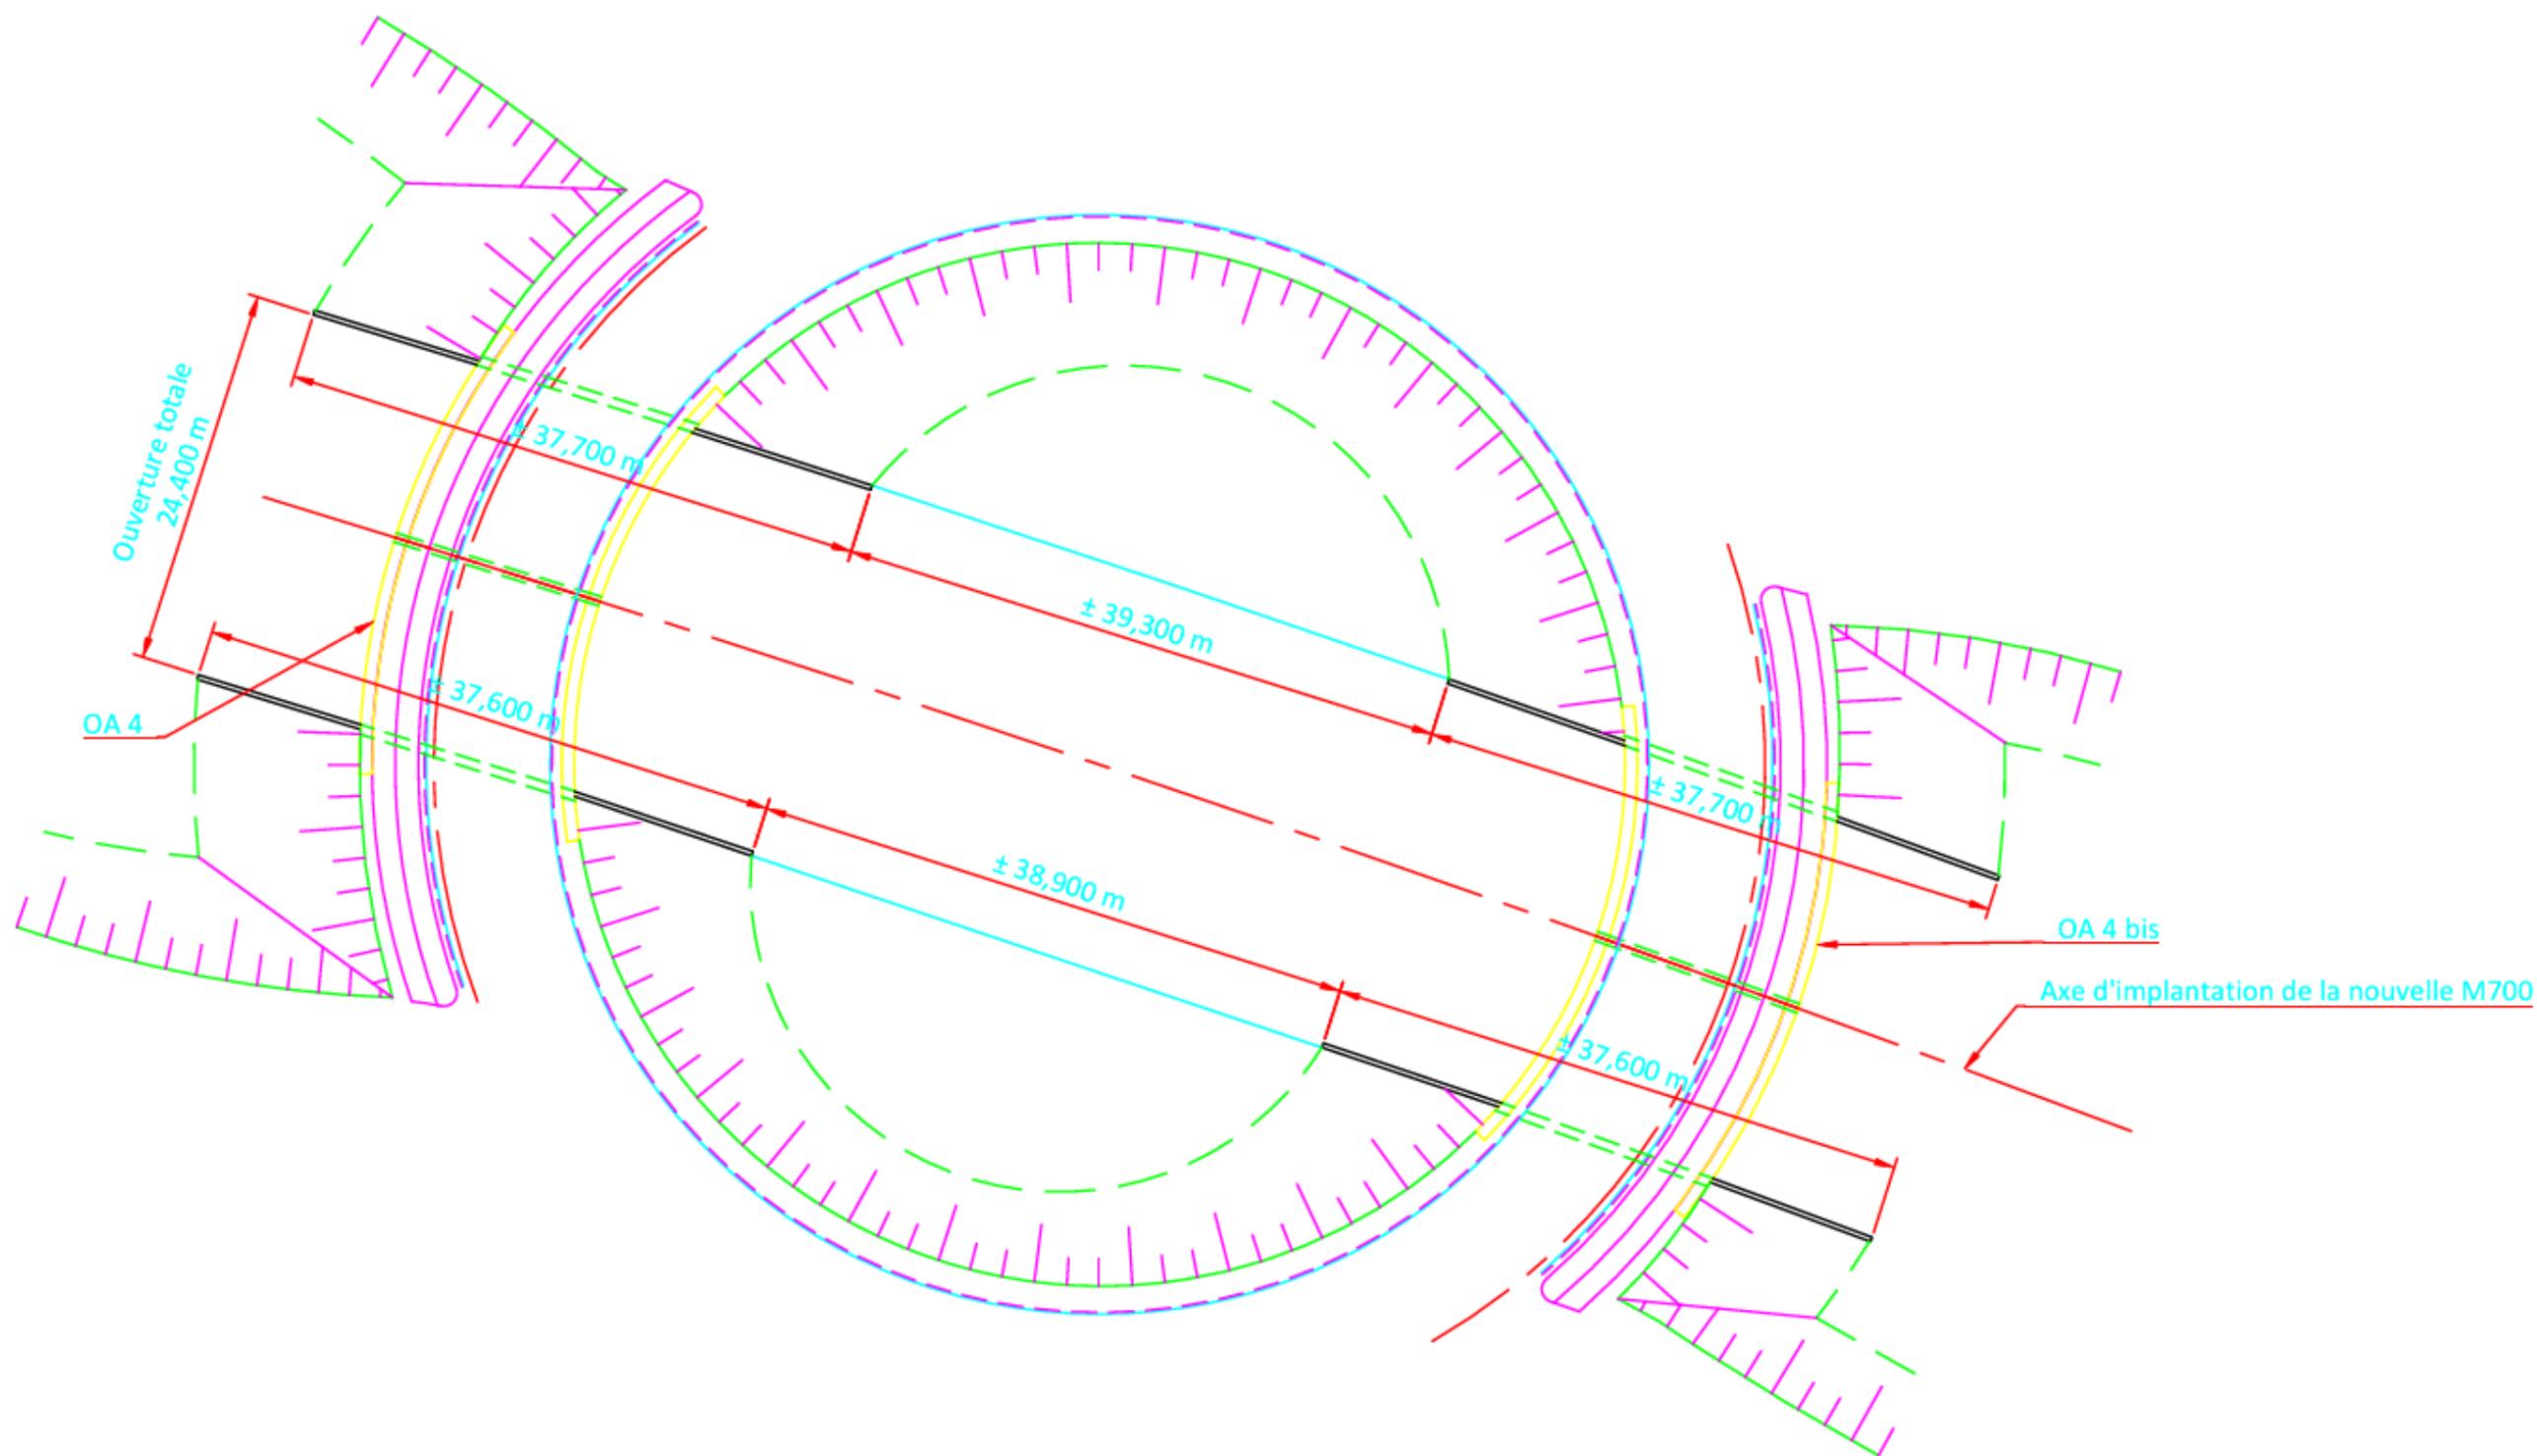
PS4 et PS4bis - Vue en plan de l'ouvrage projeté
